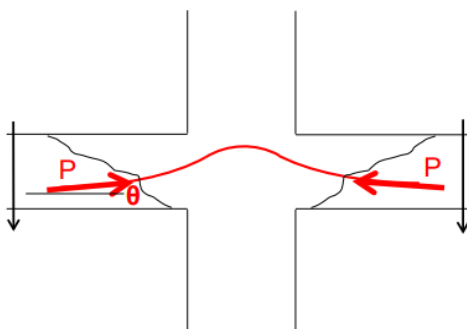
Aportación de la armadura activa frente a punzonamiento
